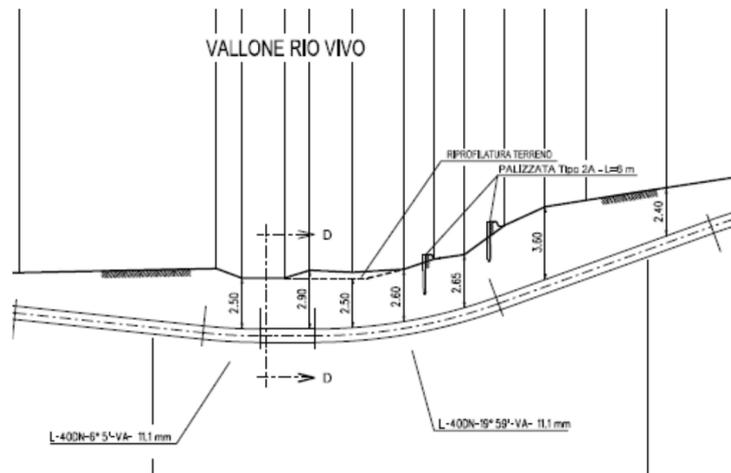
Attraversamento vallone Rio Vivo - ramo dx - Sezione schematica di progetto
